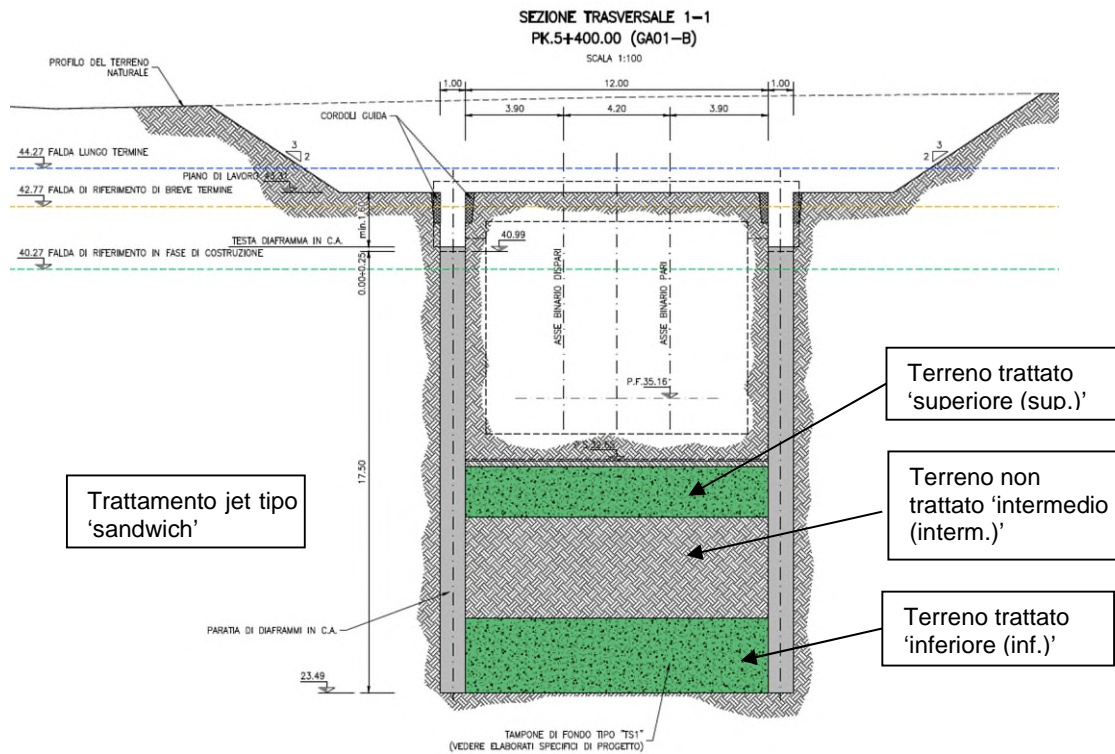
Sezione tipologica con trattamento jet tipo 'sandwich' con doppio strato
